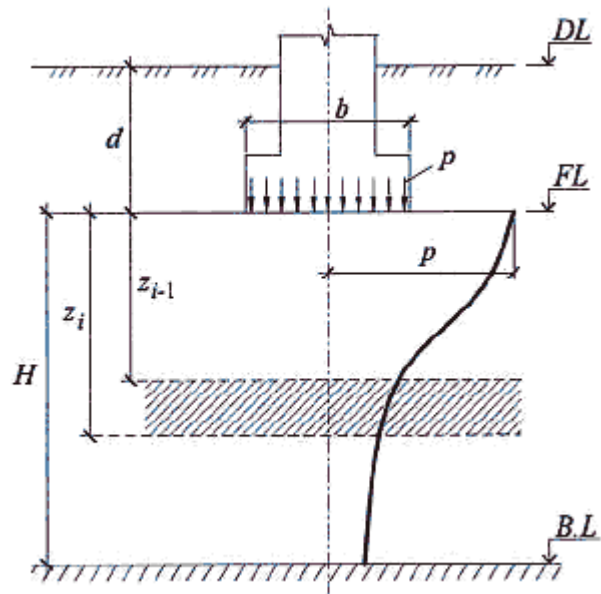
Схема к расчету осадок с использованием расчетной схемы основания в виде линейно деформируемого слоя
